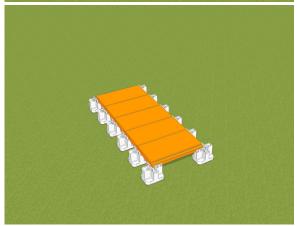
(derecha): Proceso de ensamblaje de la UNIDAD. (Pasos 1 al 3). Fuente: Elaboración propia (2018).
